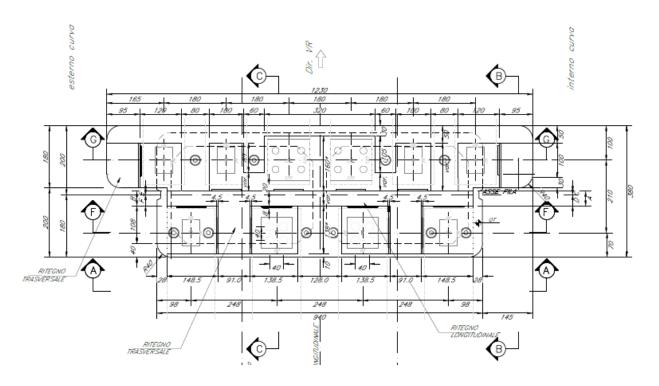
Sezioni e pianta pulvino (Allineamento fisso lato impalcato in Misto)
